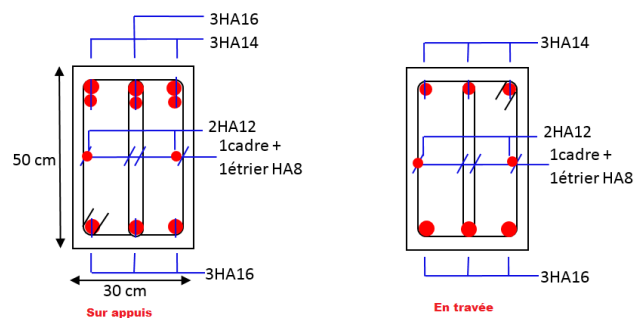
Ferraillage des poutres principales (30×50)
